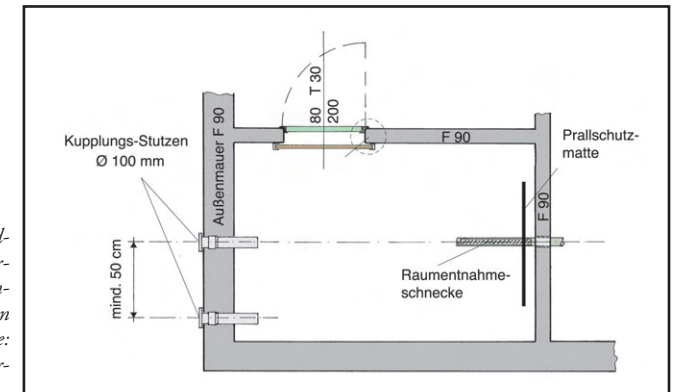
Beispiel für den Grundriss eines Pelletslageraumes mit den notwendigen bautechnischen Empfehlungen (Skizze: ÖkoFEN, Lembach Österreich)
